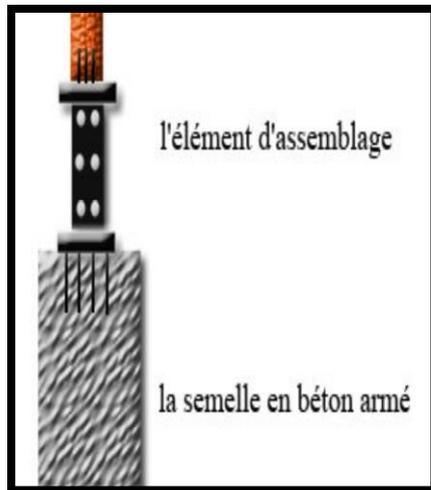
Exemple de poteau en bois lamellé collé avec fondation en béton armé
